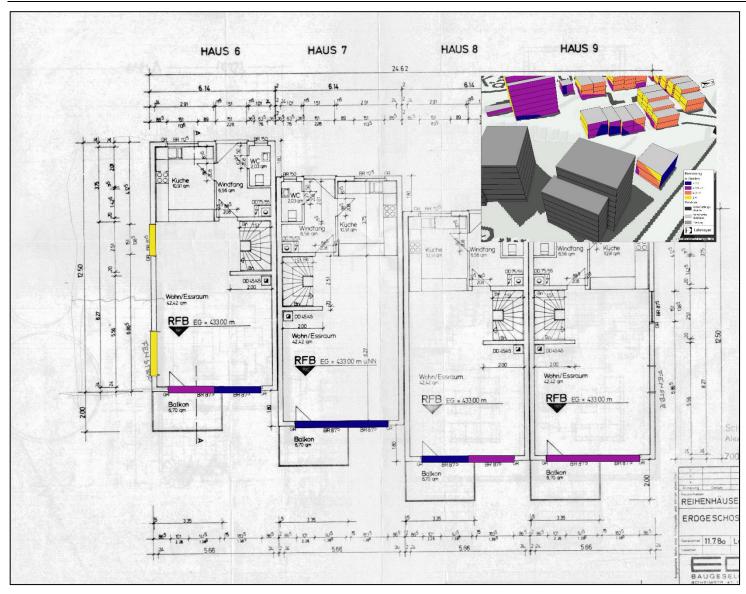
Grundrisse der Kapfstraße 42 bis 48 im Erdgeschoss und direkte Besonnungsdauer an den zur Planung zugewandten Fenstern
